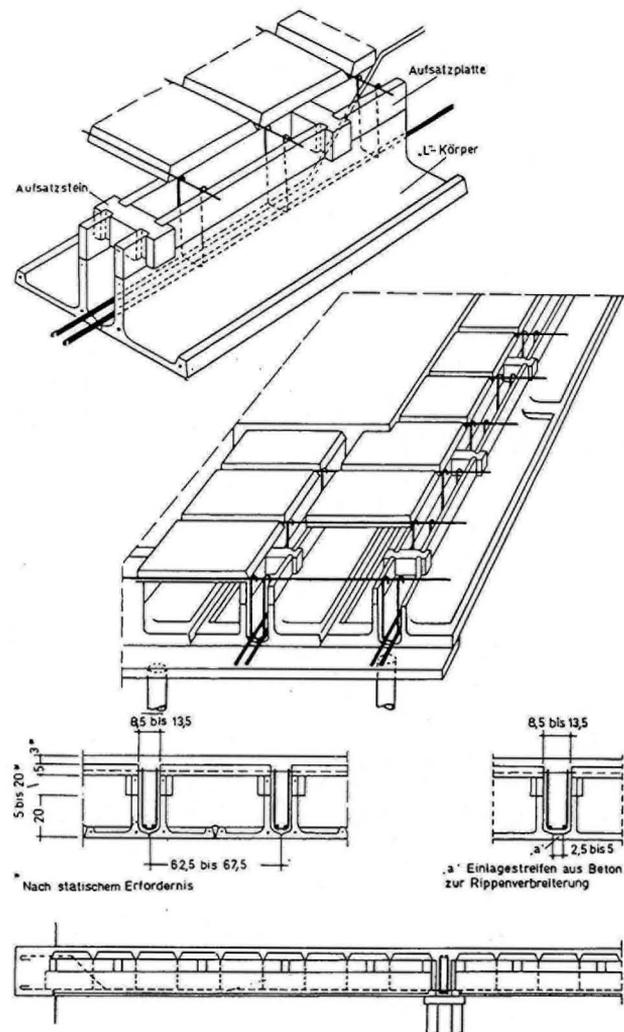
Stahlbetonschalkörper (L-Körper) mit Aufsatzplatten
